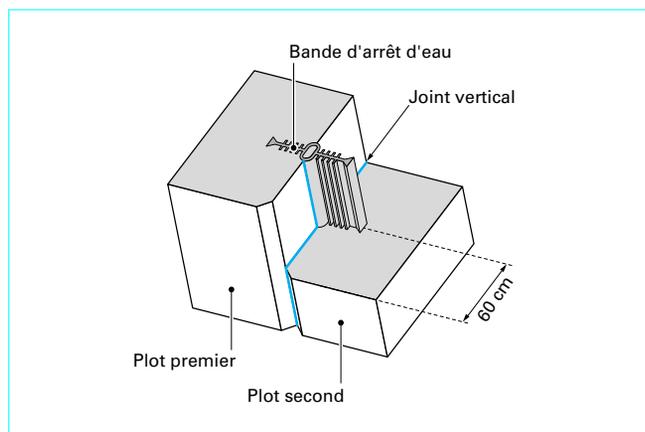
Bande d'arrêt d'eau à bulbe mise en place dans un barrage en béton [11]
